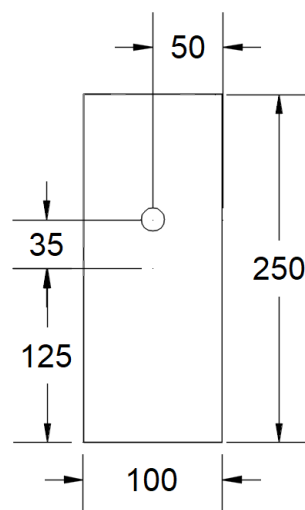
Vista de la sección transversal del espécimen. (Fuente: Elaboración Propia)
